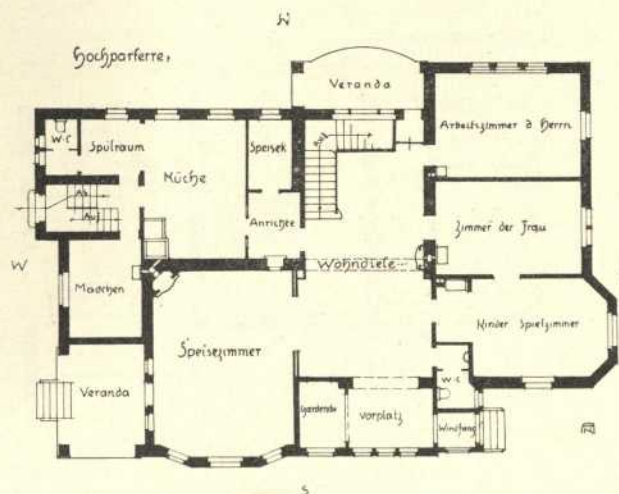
und 8 stellen die Grundrisse eines größeren Landhauses vor. Die vorhin besprochene Situierung ist auch hier zu finden. Hauptgewicht wurde auf den Eingang gelegt. Er besitzt Windfang, Vorplatz und Kleiderablage und bildet einen sicheren Windverschluß. Auch der Verschluß an der Diele zur Gartenveranda ist doppelt. Diele und Speisezimmer können mittels einer Schubwand verbunden werden. Die Wirtschaftsräume sind in einer Gruppe vereinigt, die Anrichte bildet die Verbindung zu den anderen Räumen.
